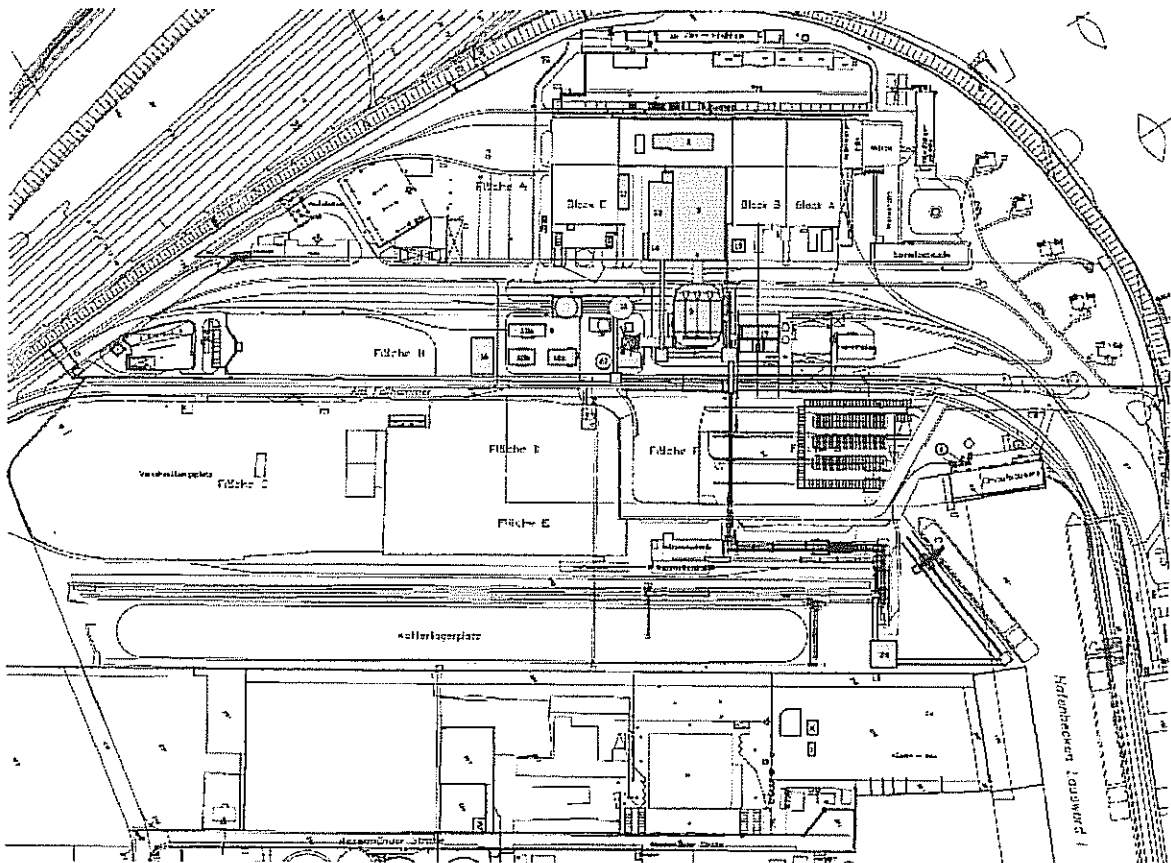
Lageplan Kraftwerk Lausward mit vorhandenem Kohlelager
